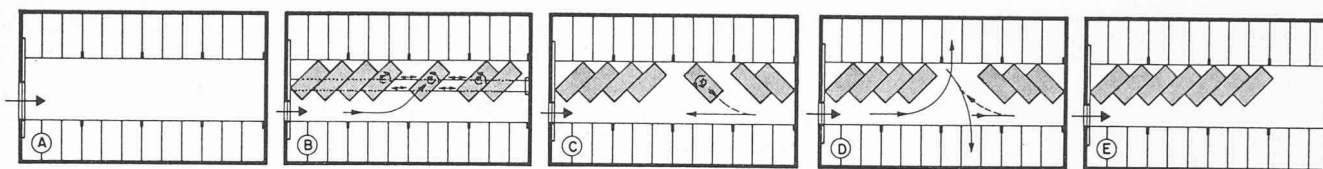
Schéma de principe d'un garage avec installation automatique de plates-formes Rotex dont l'axe est incliné de 45° par rapport à la voie d'accès et pouvant se déplacer parallèlement à cette voie. A : disposition usuelle d'un garage avec places de stationnement situées le long des deux murs longitudinaux. B : le même garage complété par sept plates-formes tournantes Rotex augmentant de 35 % le nombre des voitures
